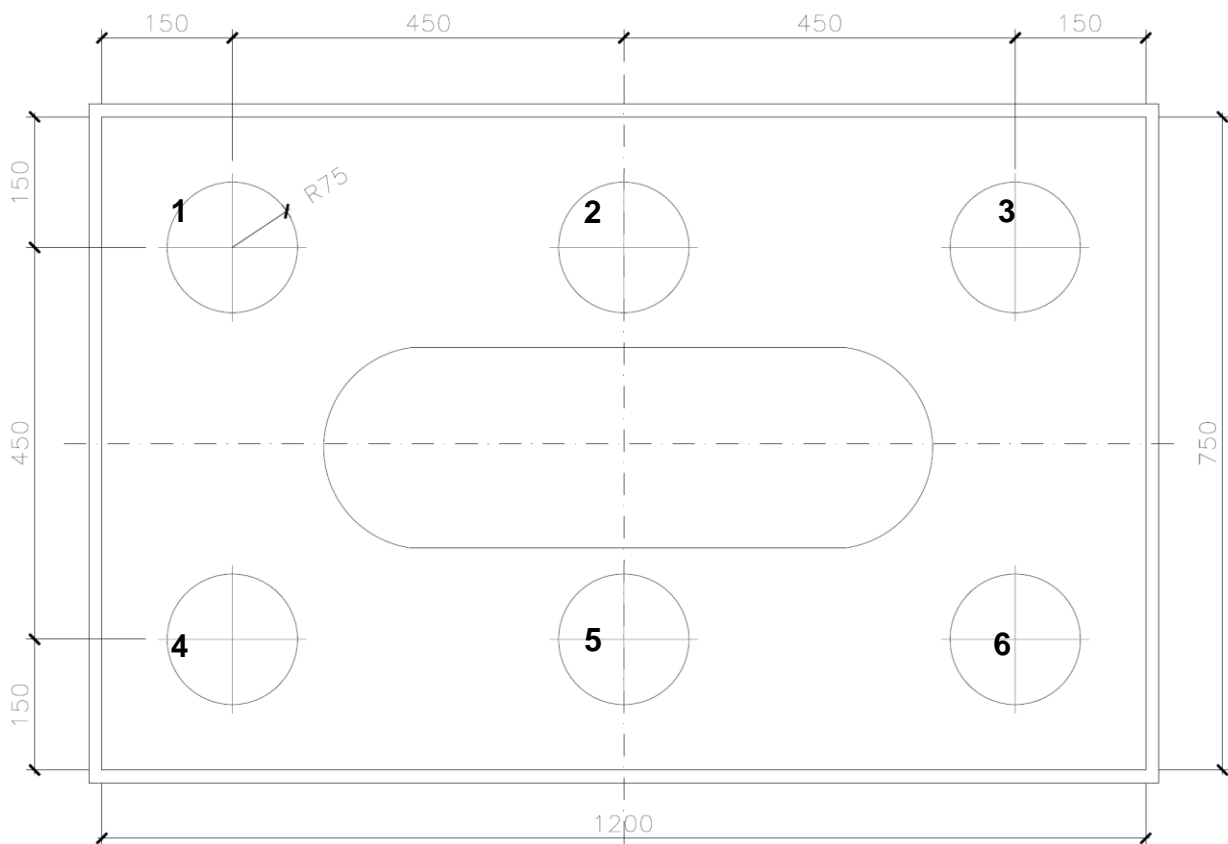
Vista in pianta – Plinto di fondazione – Denominazione pali
